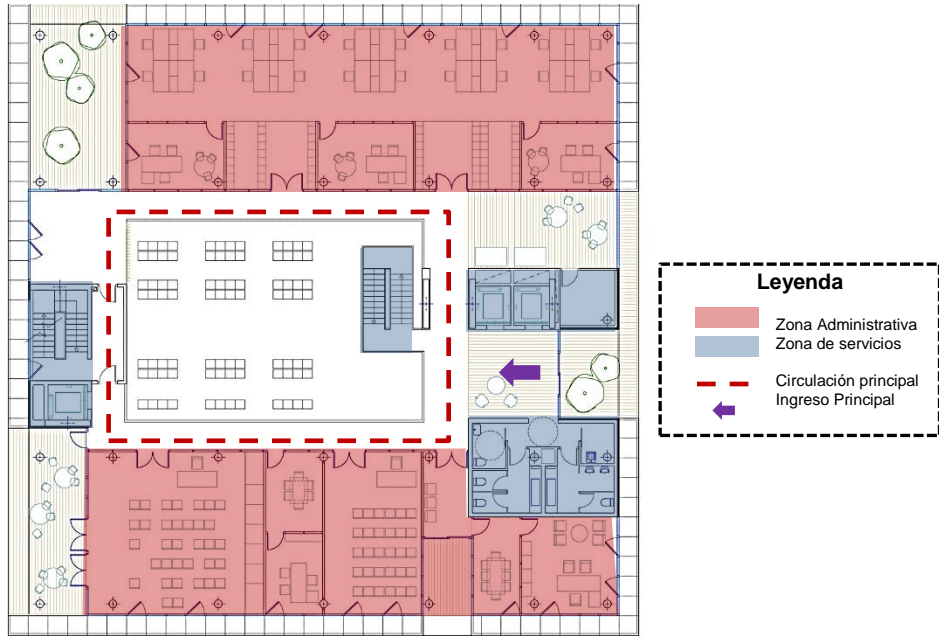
Esquema primera planta – Comisaría Fuencarral
